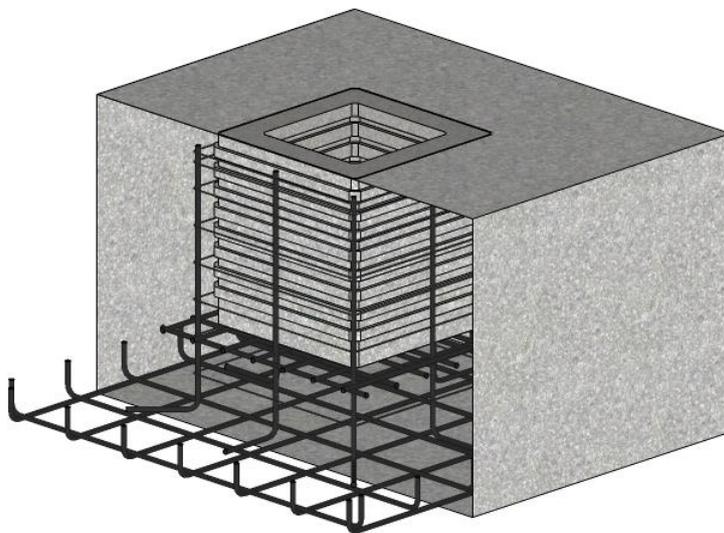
Zapata tipo Cáliz. Fuente: Jaime Santa Cruz, SketchUp , TEMA (2024).
